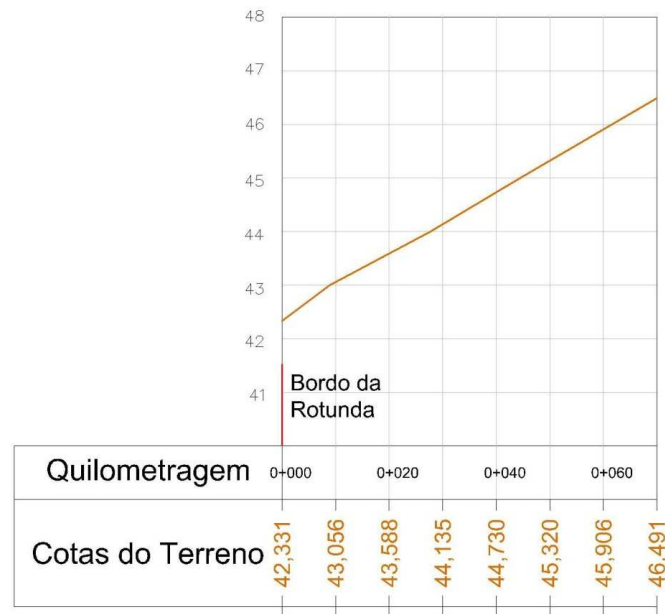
Perfil longitudinal do terreno pré-existente do Ramo B.
